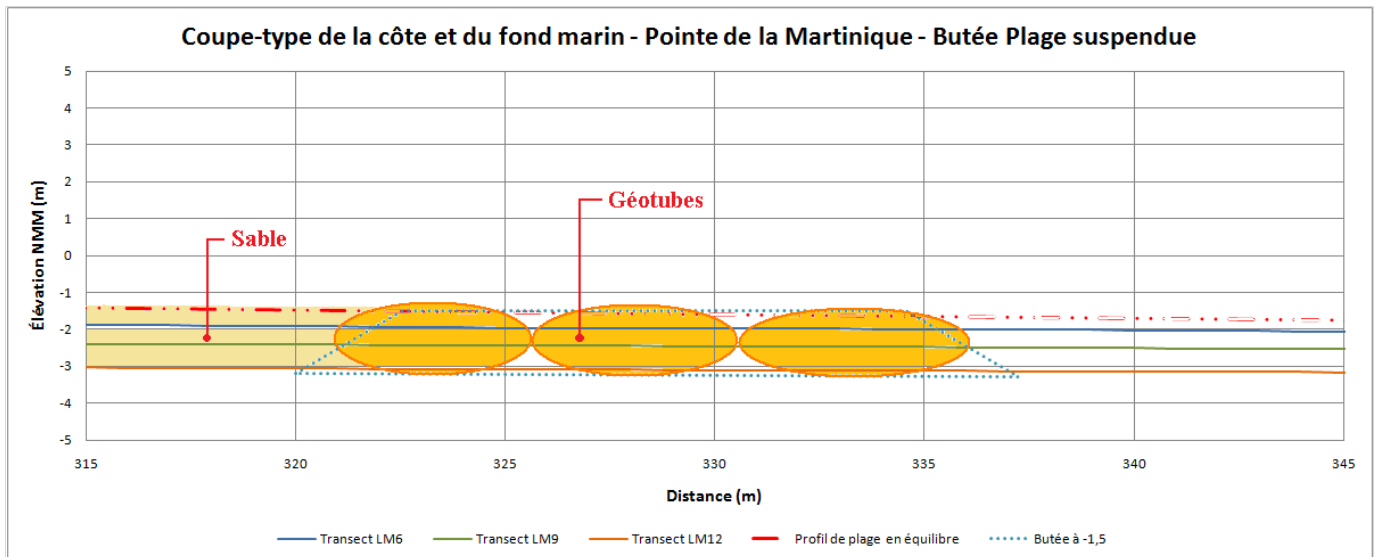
Coupe type d'une butée de pied de plage suspendue en géotubes à -1,5 m NMM
